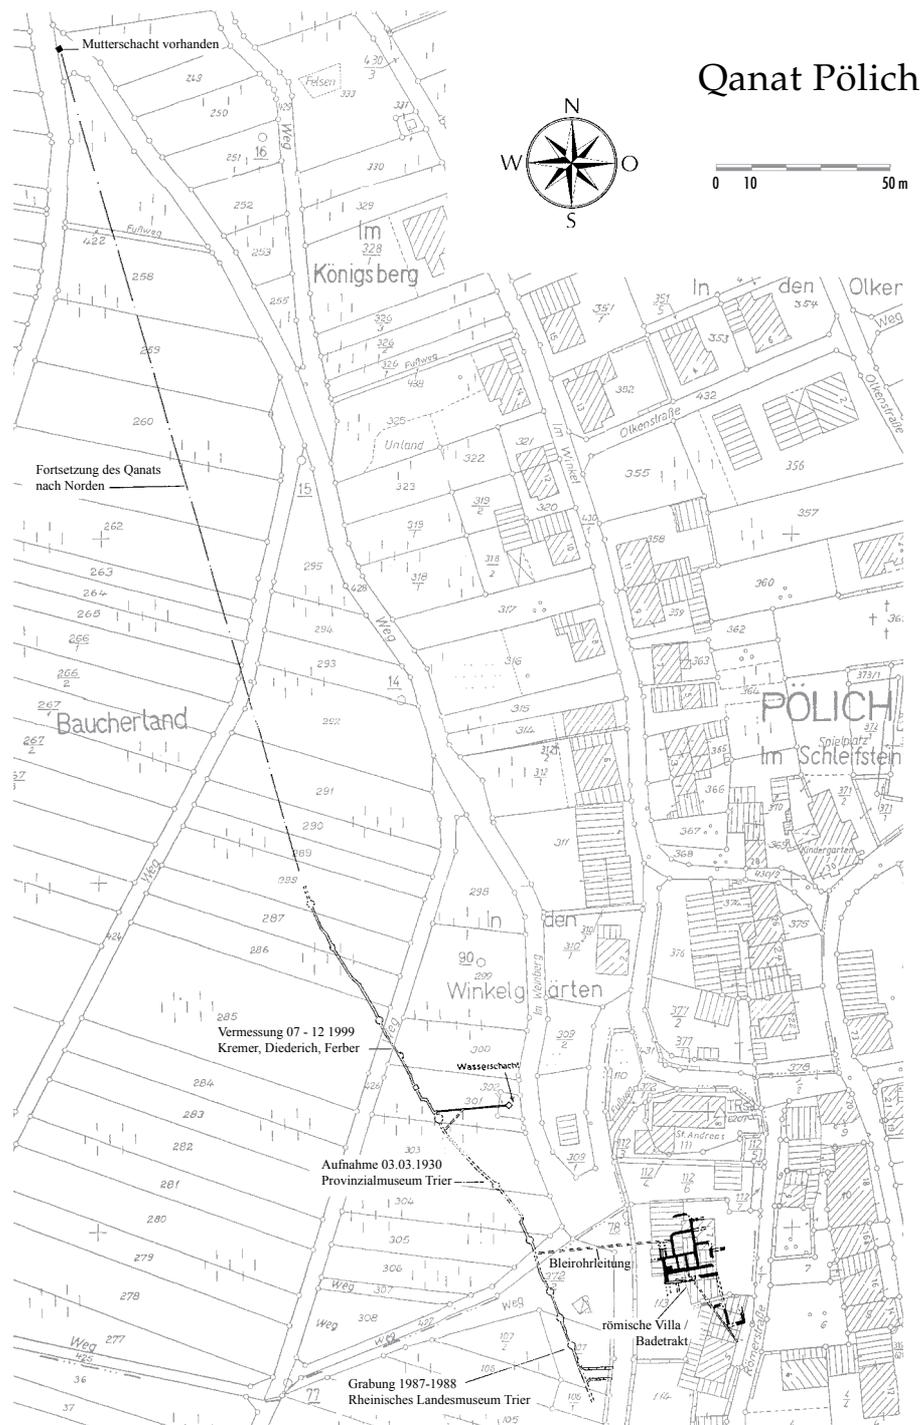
Lageplan mit Eintragung des Tunnels und der römischen Villa.
